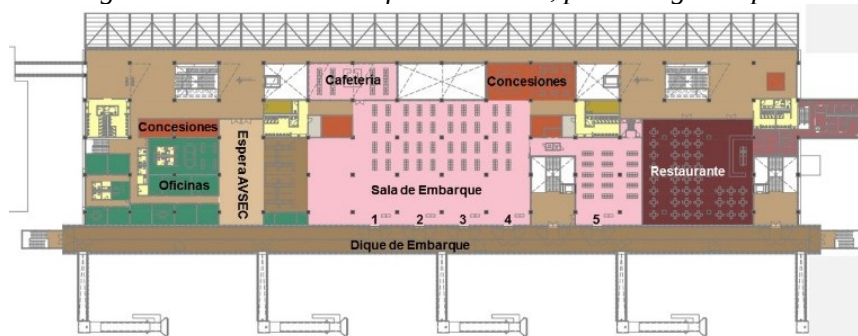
Nuevo Edificio Terminal, planta primer piso
